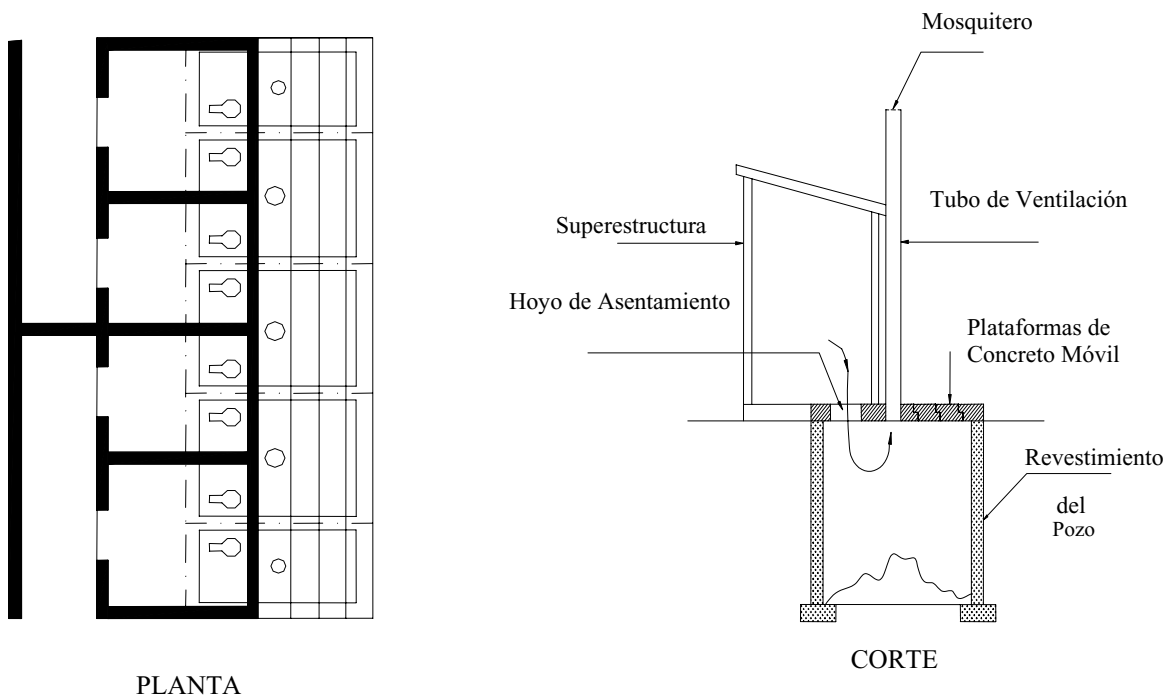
LETRINA MÚLTIPLE ALTERNANTE
